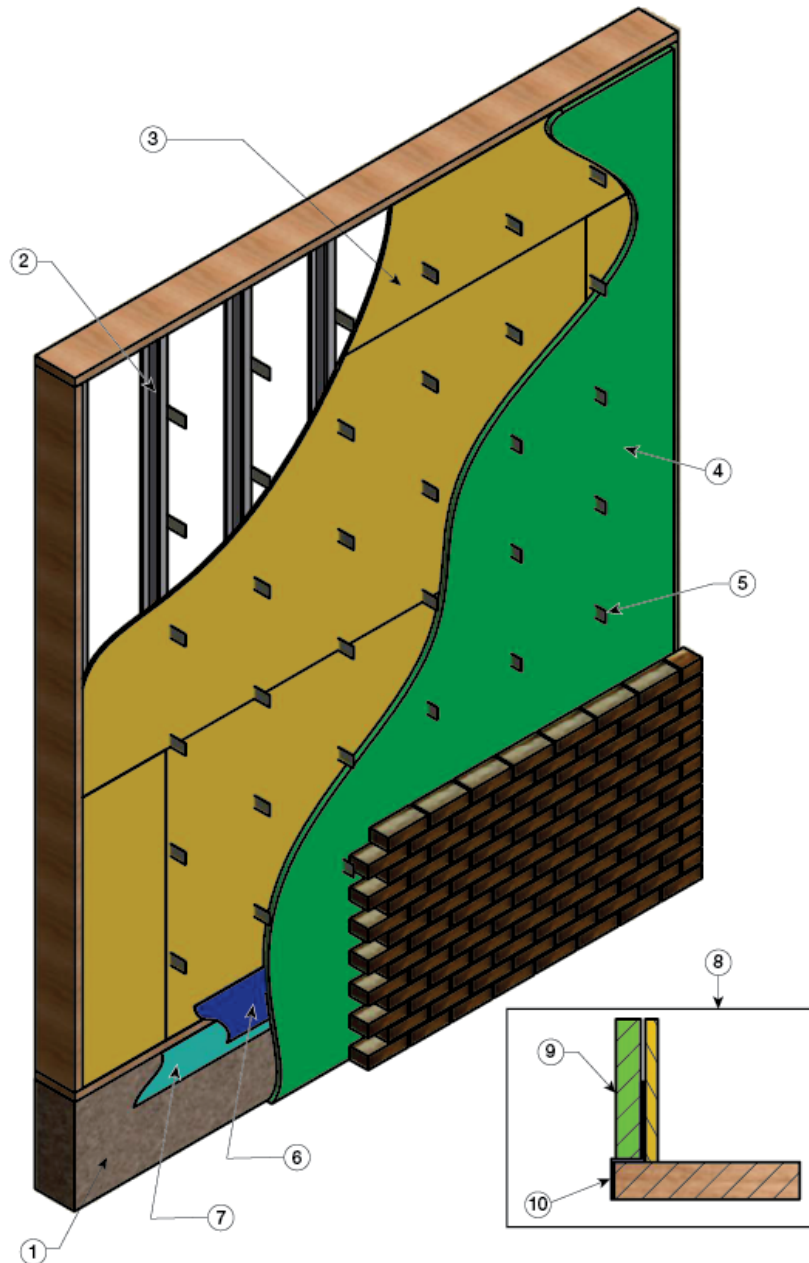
Détails d'exécution du système d'étanchéité à l'air - mur de fondation et agrafes à brique :
